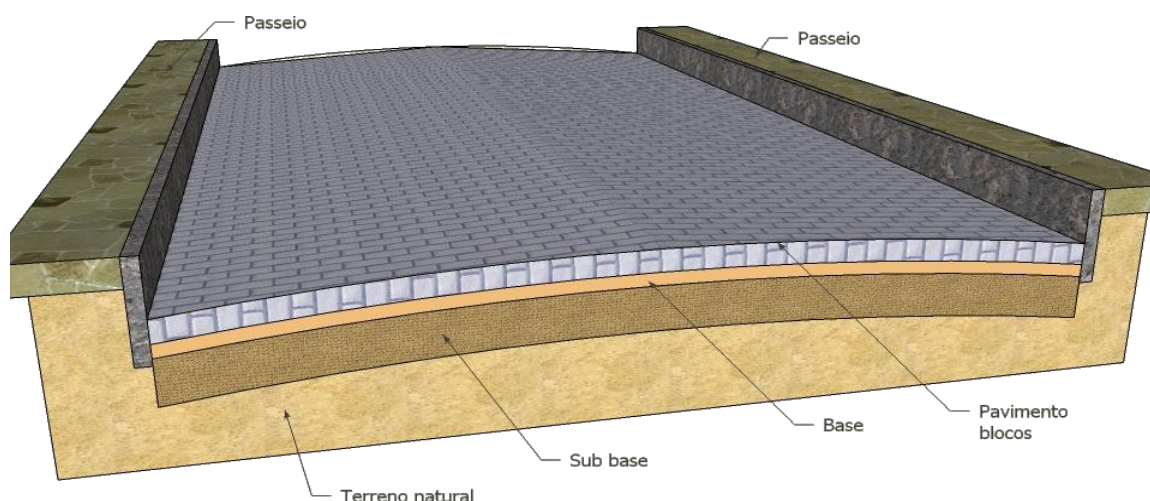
Desenho esquemático do perfil transversal da pavimentação
